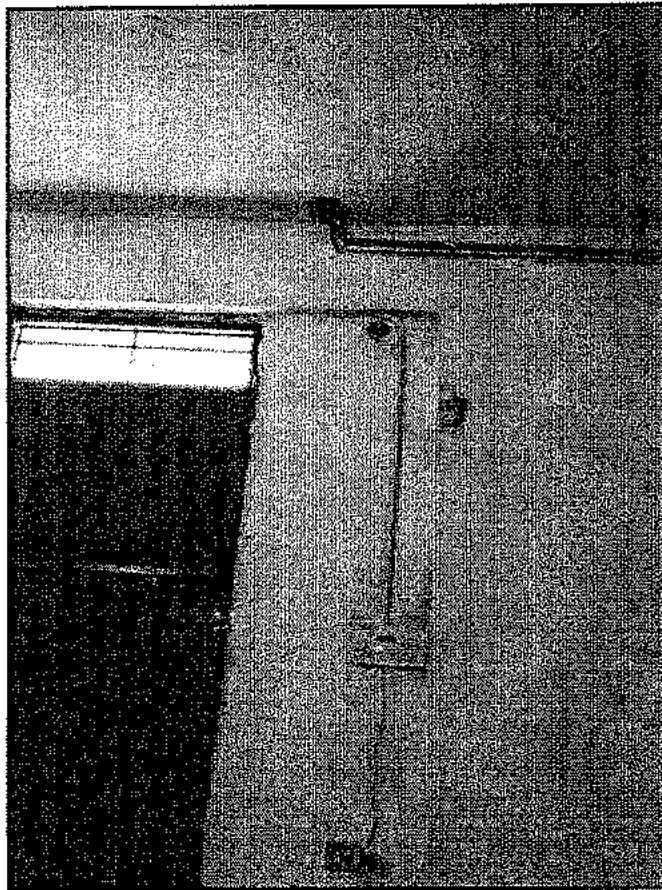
Particolare del rilevatore ad infrarossi antifurto
